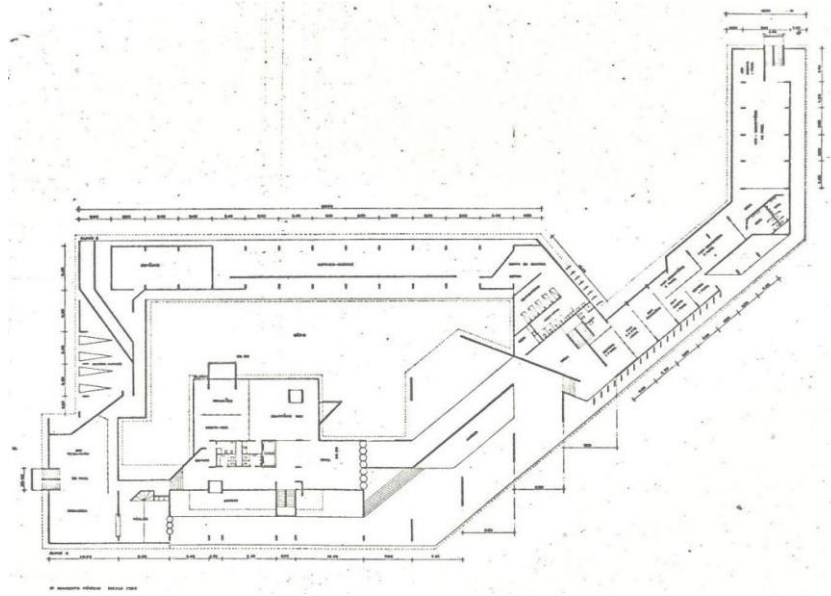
Planta baixa da Sede da Rede Ferroviária.
